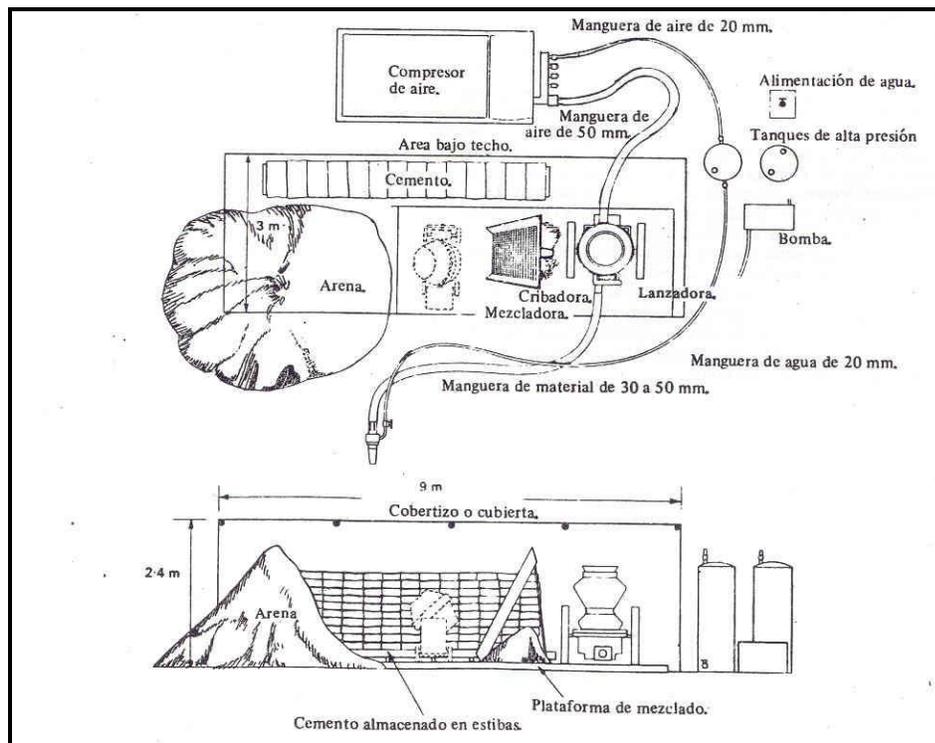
Distribución típica de una planta pequeña.^{1/}
